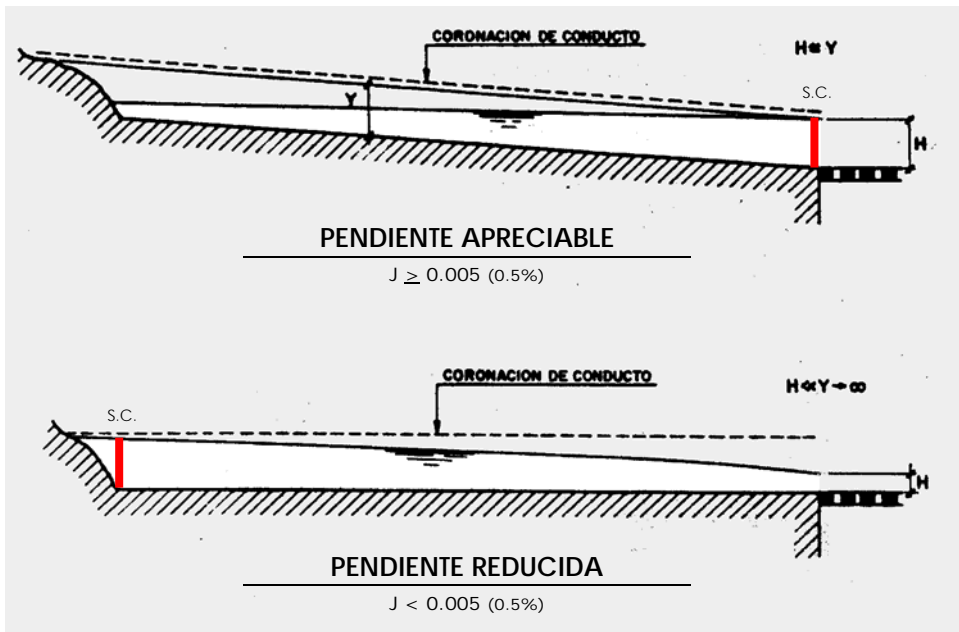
Secciones críticas de cálculo en elementos lineales de desagüe
